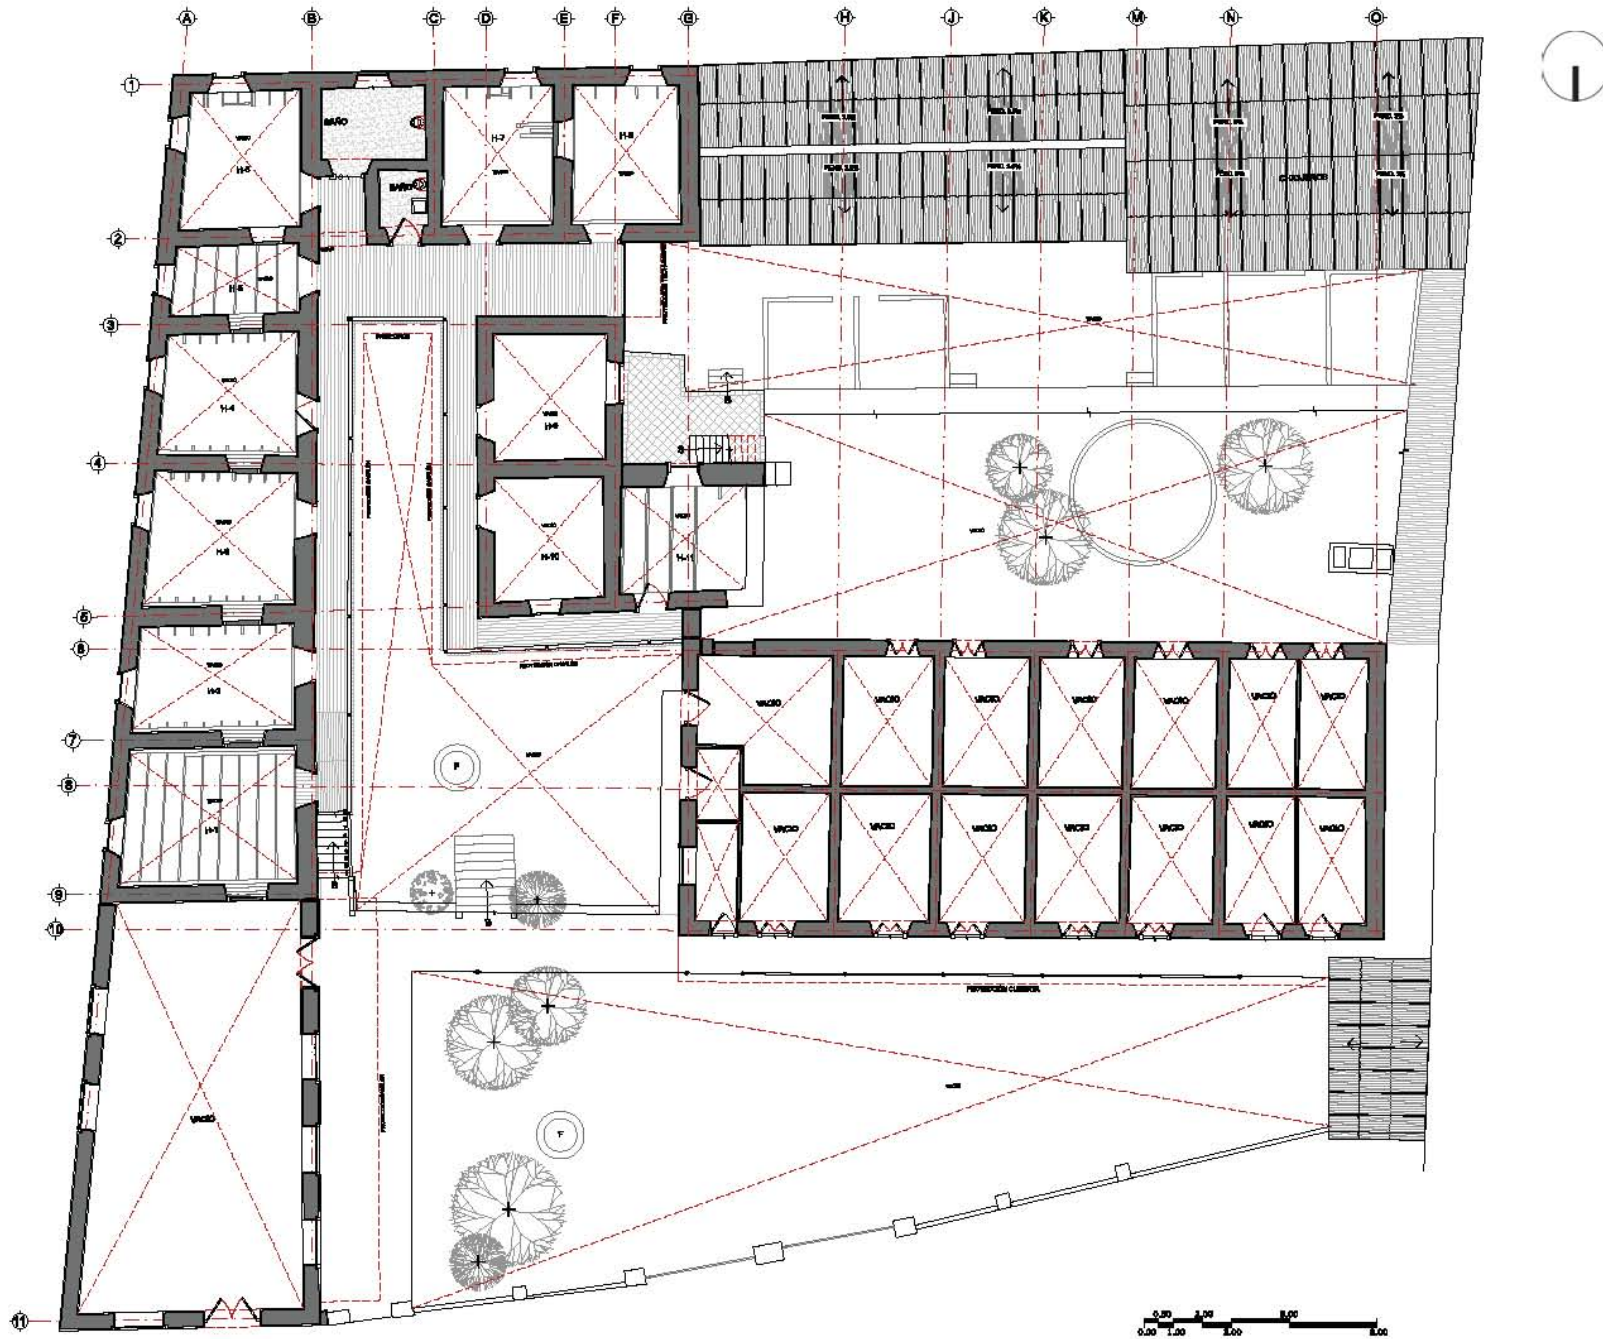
Levantamiento de la planta alta del "Hotel del Jardín"
